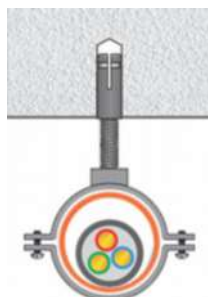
Монтаж ОКЛ при помощи резьбовой заклепки и винта к поверхности из сэндвич-панелей
